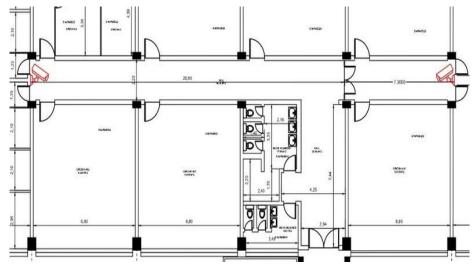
Plano actual de distribución de cámaras del piso 4
